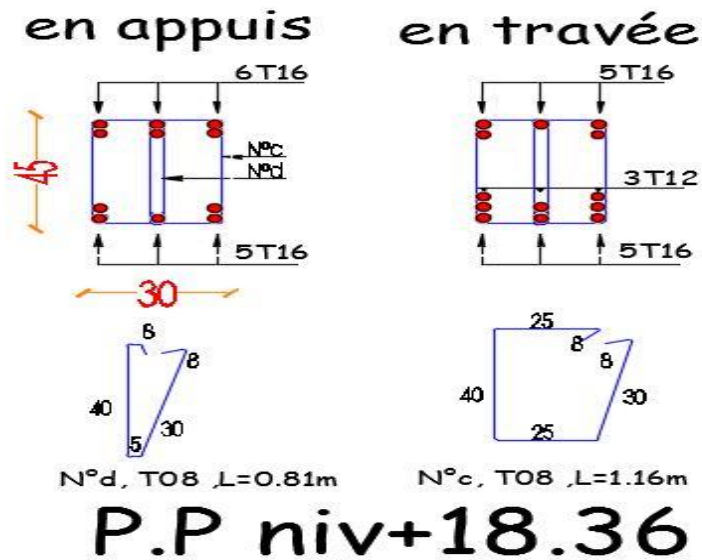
ferrailage du poutre principale niveau +18.36
